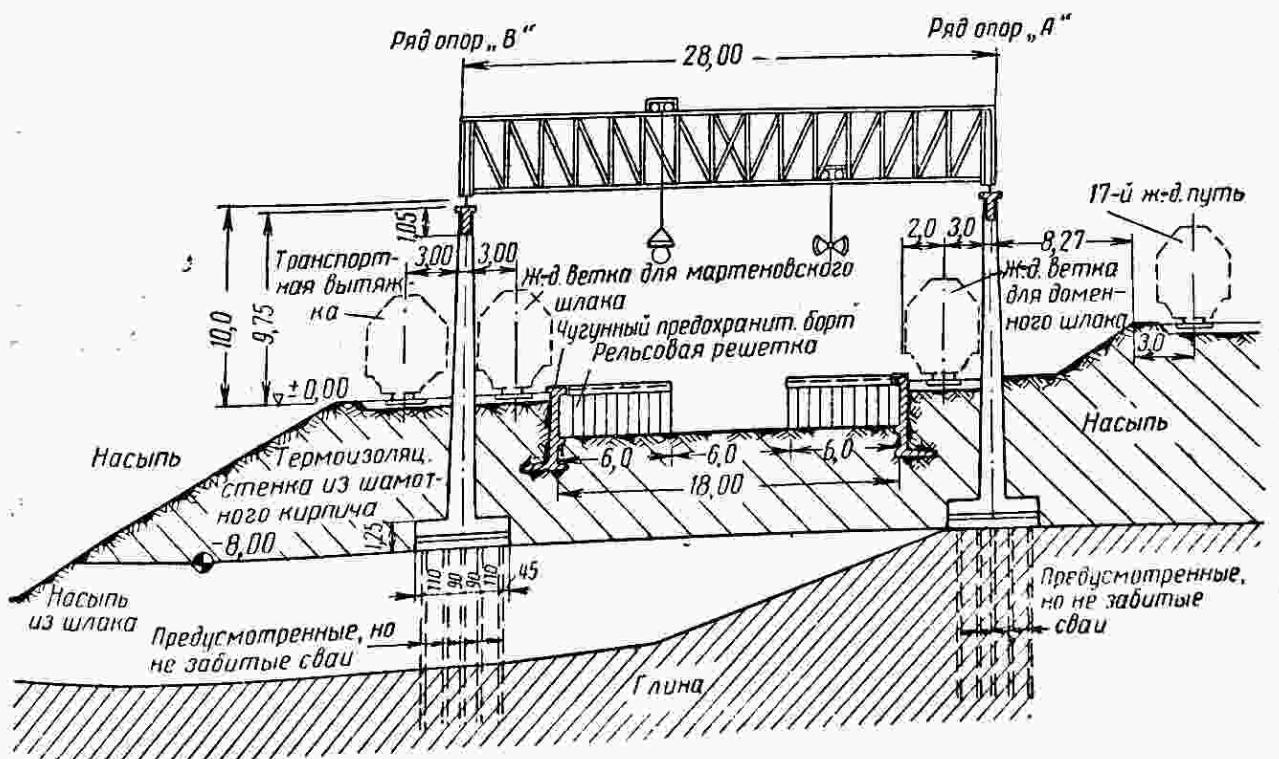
Фундаменты подкранового пути шлако-грануляционной установки
